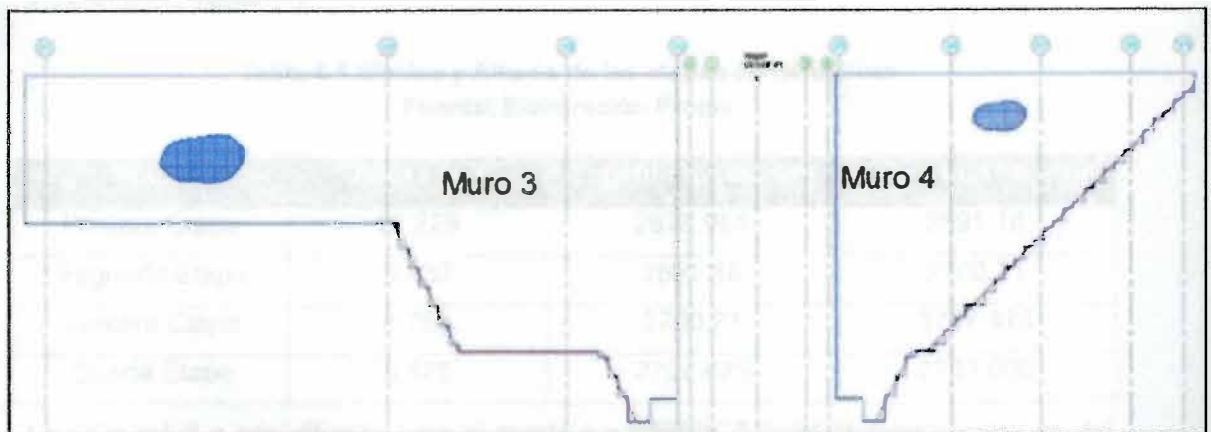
Esquema Muro 3 y Muro 4 – Chancadora Primaria 2
